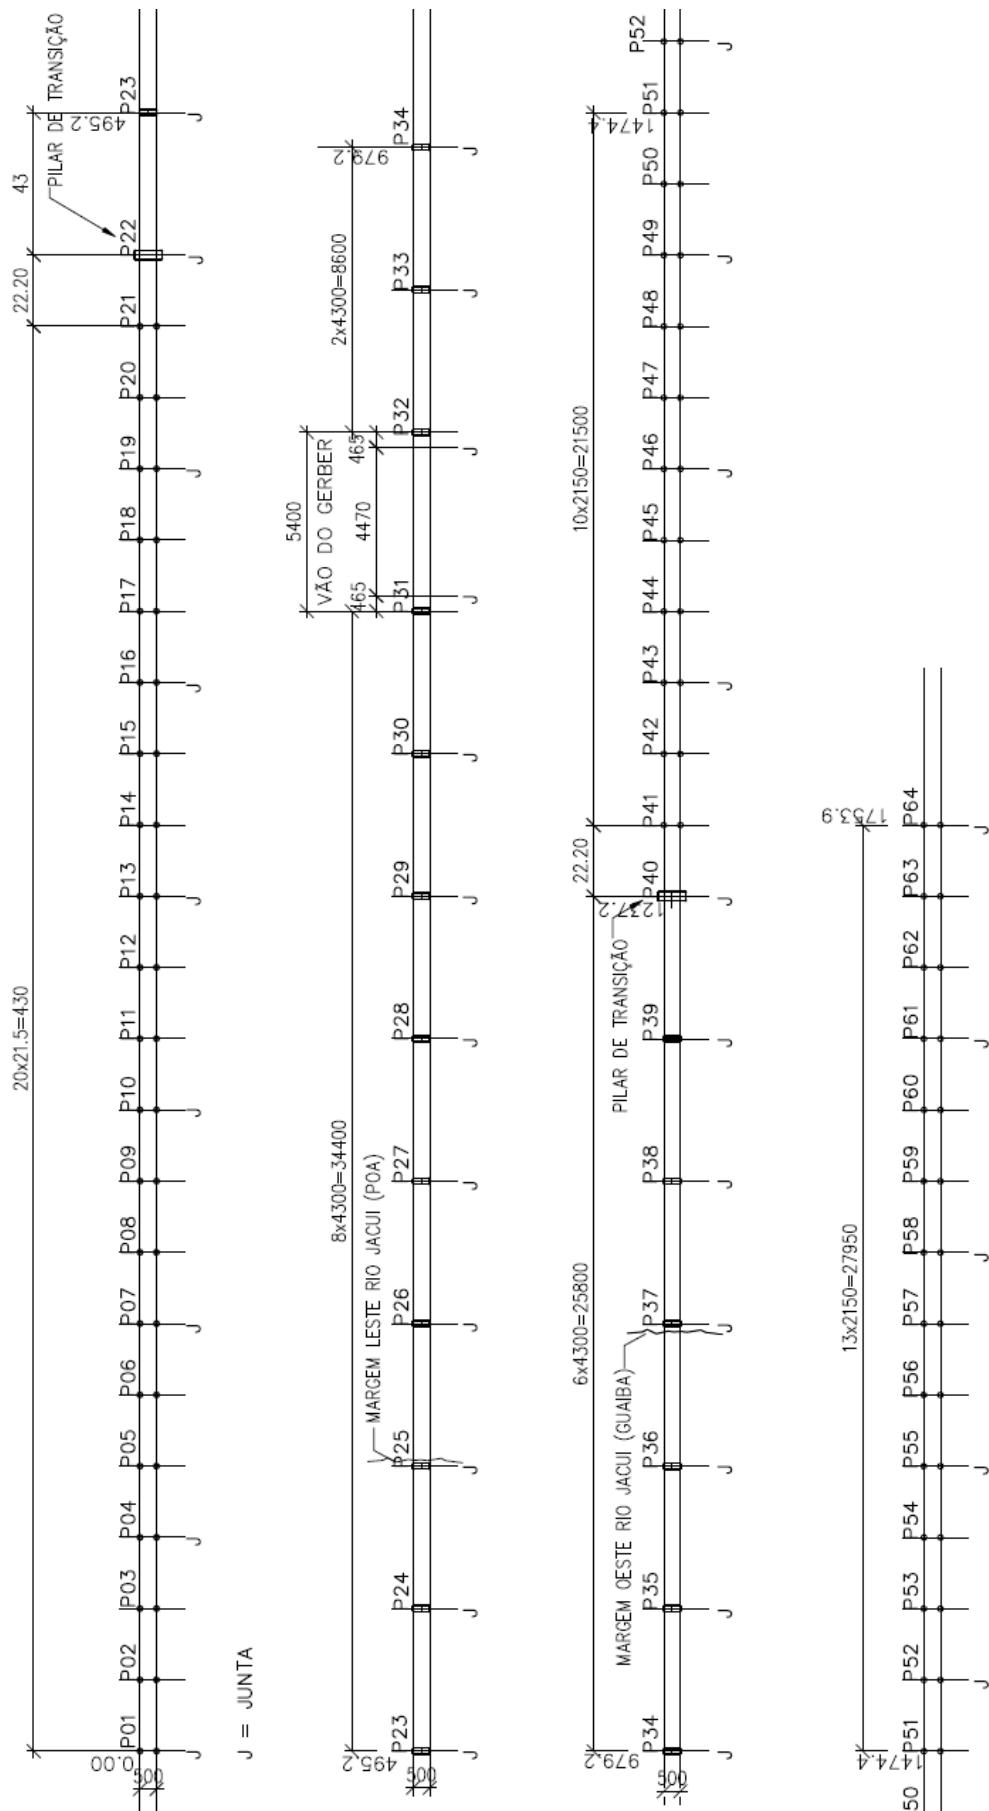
locação dos pilares da ponte sobre Rio Jacuí - Obra Norte
